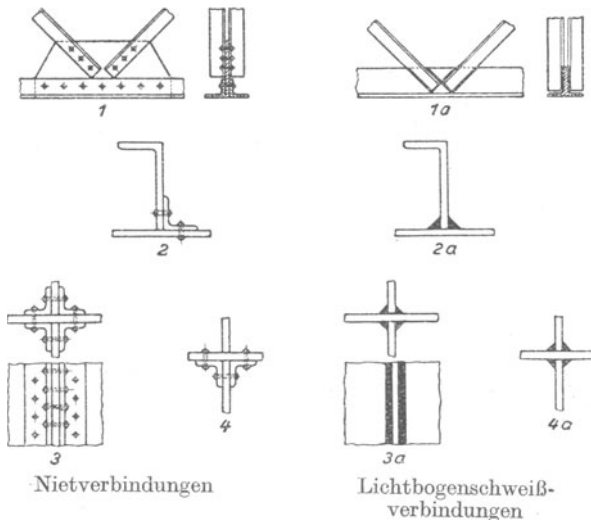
Elektrische Lichtbogenschweißung als Ersatz für Nietung.
